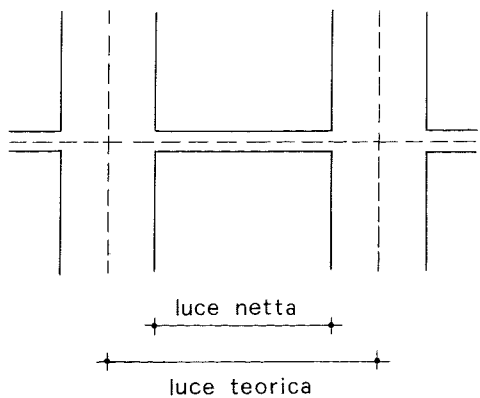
Pilastri con sezione di dimensioni non trascurabili rispetto alla luce.
